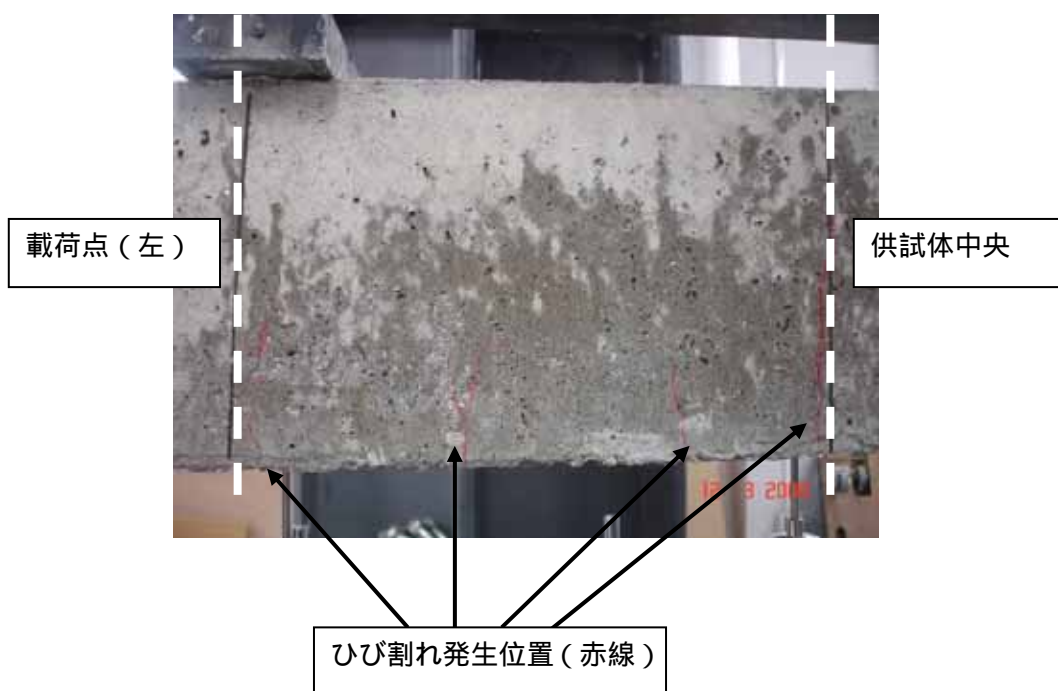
初期載荷終了時のひび割れ性状の例
